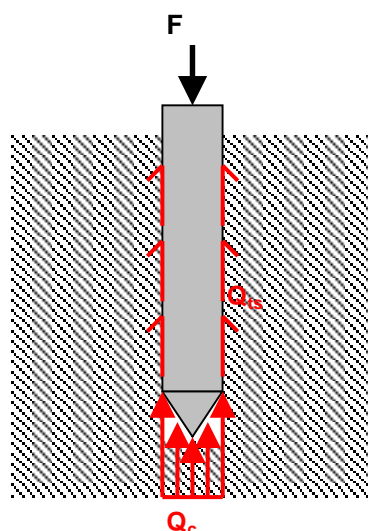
schéma de principe de l'essai au pénétromètre statique
